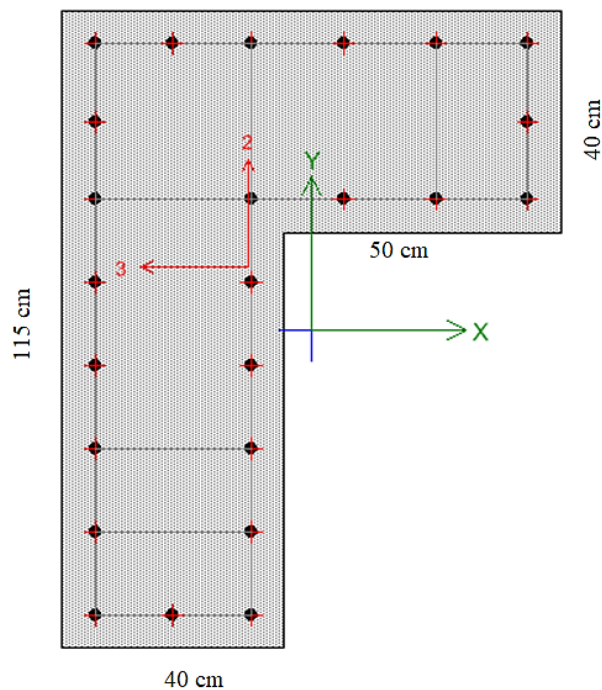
Columna C1-Acero Longitudinal - Sistema estructural tradicional.
